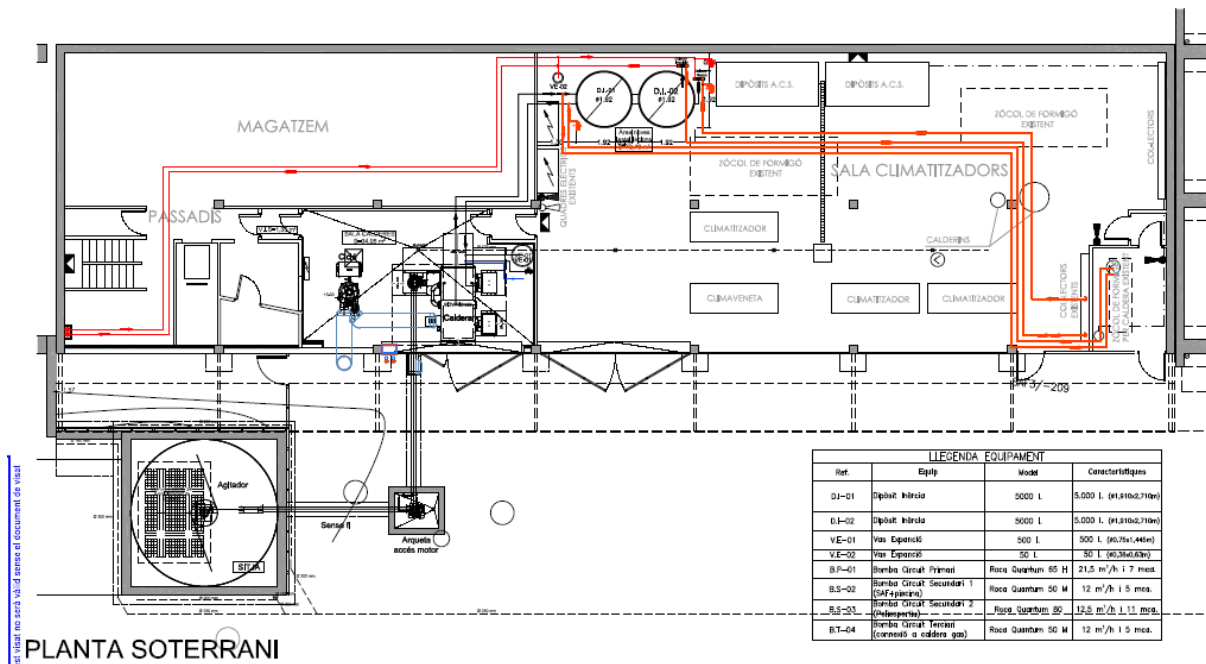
Planta distribució sala de calderes i sitja (Font: Projecte executiu - CCVOC)
